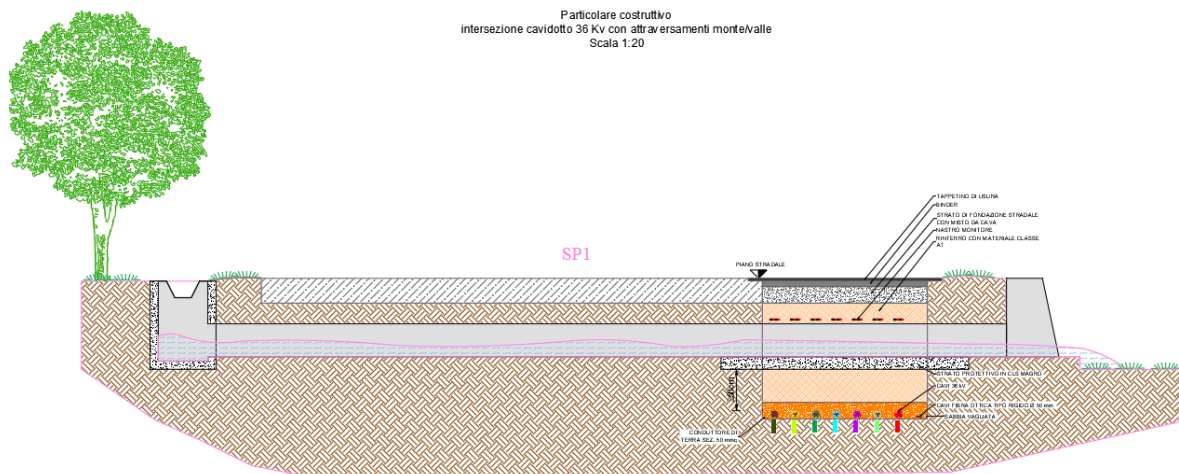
Sezione trasversale tipologica attraversamento Cavidotto 36 kV manufatti monte/valle
